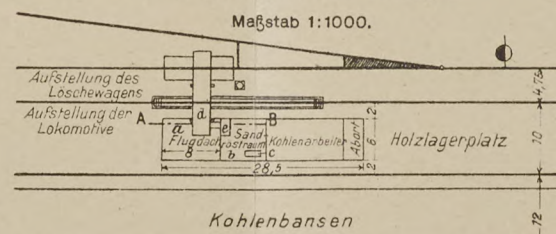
Grundriß der Besandungs- und Aschenabfuhr-Anlage. Maßstab 1:1000.
